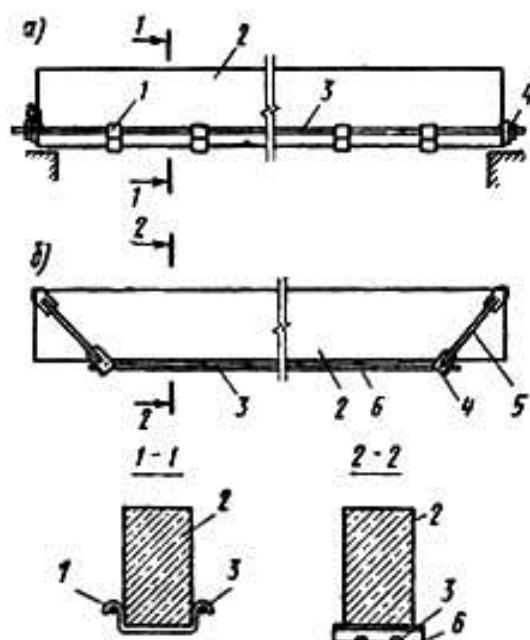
Усиления балок предварительно напряженной арматурой: а – линейной; б – спиральной; 1...3, 6 – соединительные элементы (2 – усиливаемая балка; 3 – напрягаемая арматура); 4 – натяжное приспособление; 5 – наклонные ветви опорного устройства
